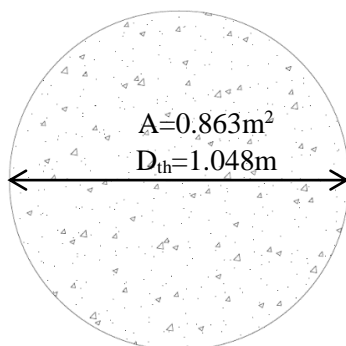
Sección del tapón de hormigón para la conexión con pilote vertical.
